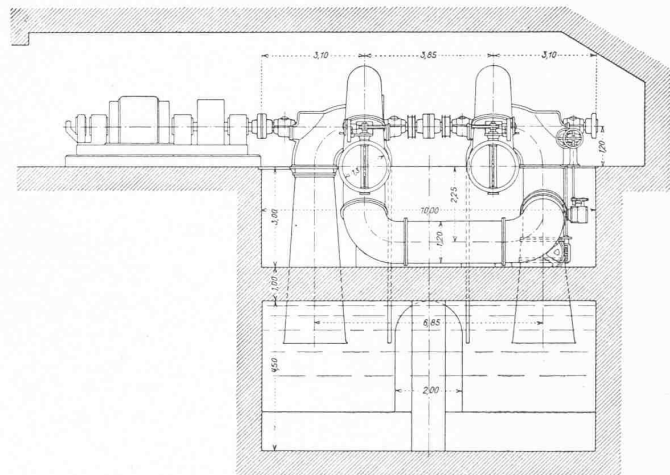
bis 45. Schnitte und Grundriss der Druckverminderungs-Anlage am Lac d'O6. — 1 : 200.
